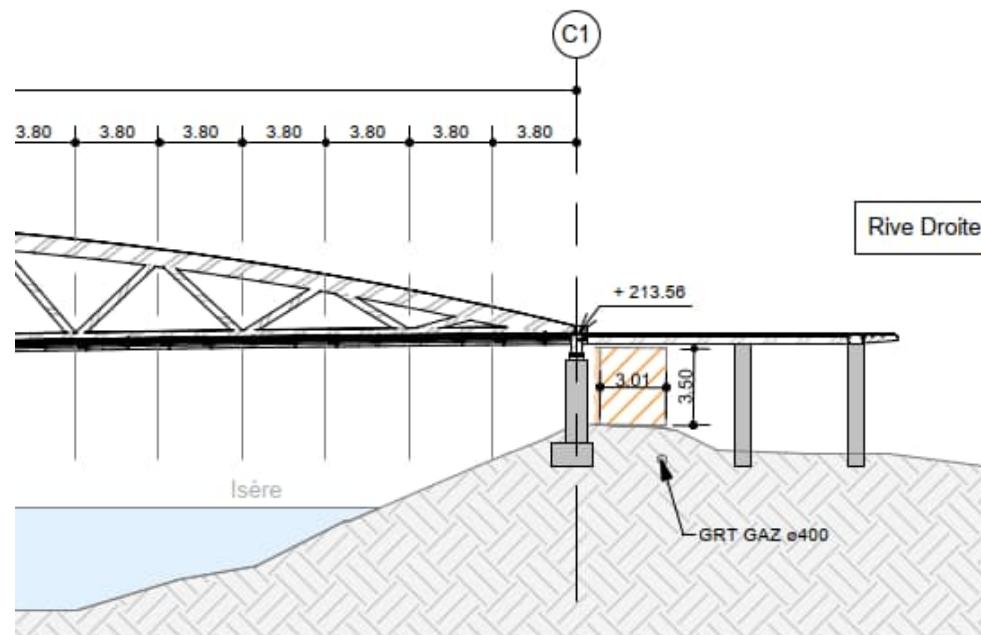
Hauteur libre pour la passerelle au niveau de la piste cyclable existante et préservation de la transparence le long de la rive droite
